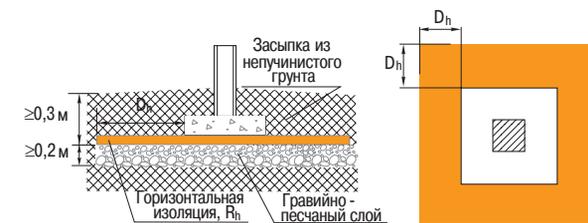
Схема поперечного разреза и план расположения изоляционных плит «Пеноплэкс®» для отдельно стоящих колонн
